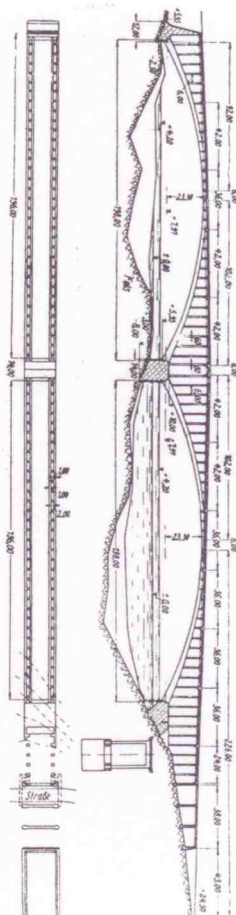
Planta e corte longitudinal do Projecto Emperger.
